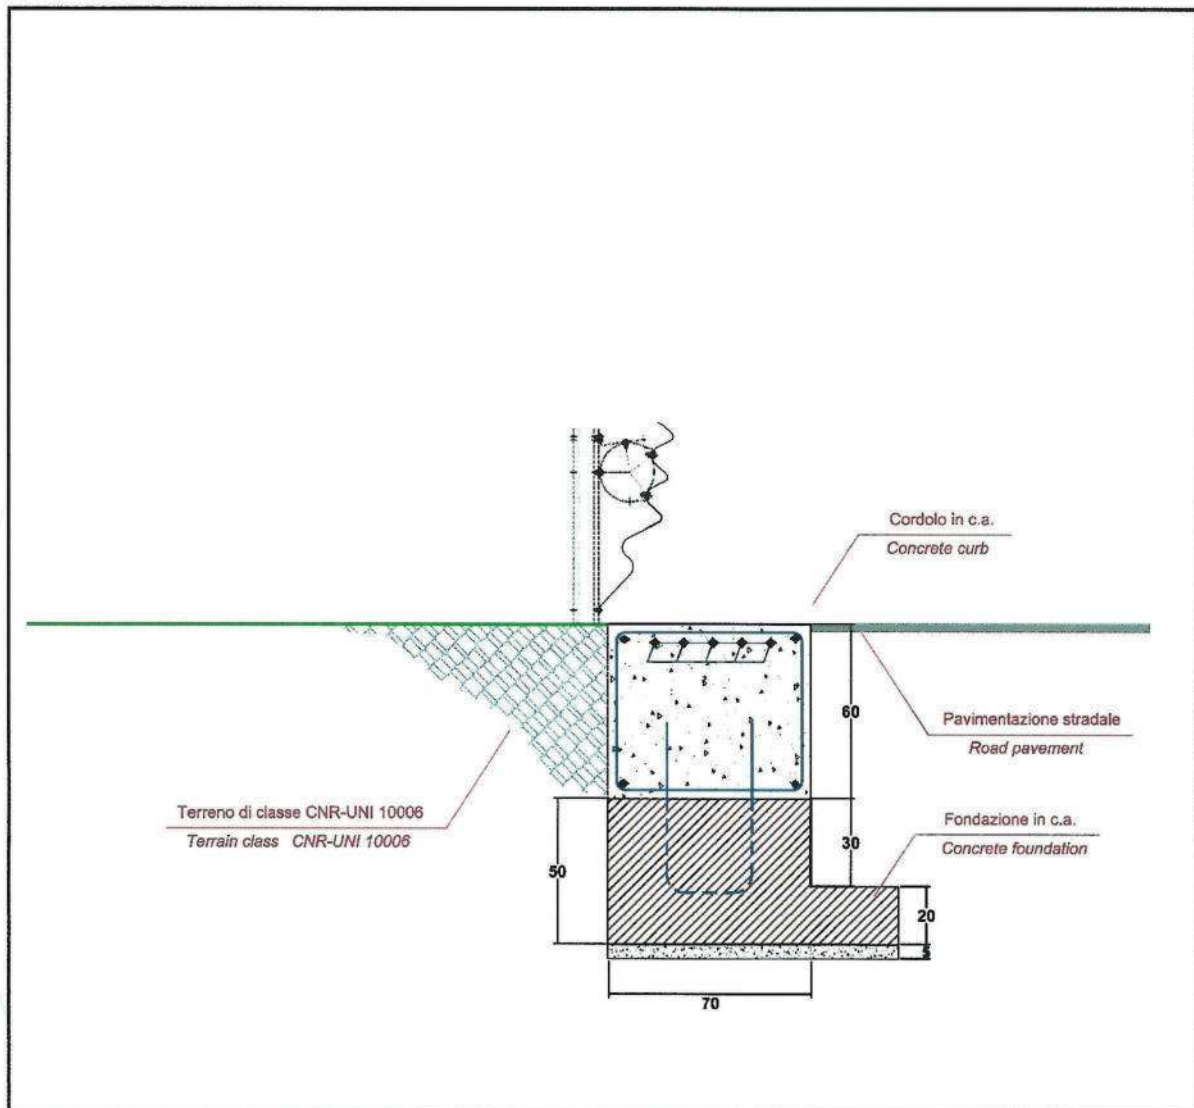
Figure 2 Sezione dell'installazione – The installation section
